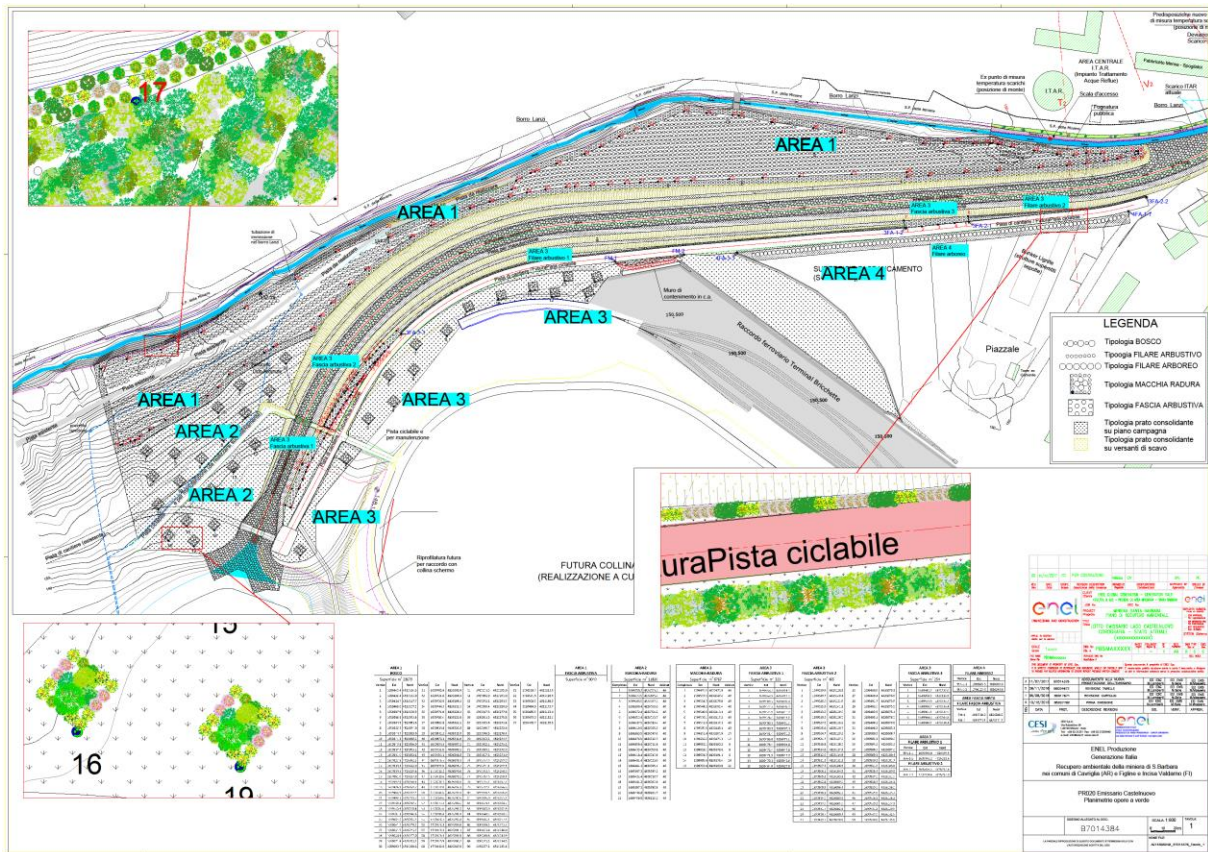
I. Planimetria delle opere a verde (estratto tavola 1 prot. B7014376 in allegato).
